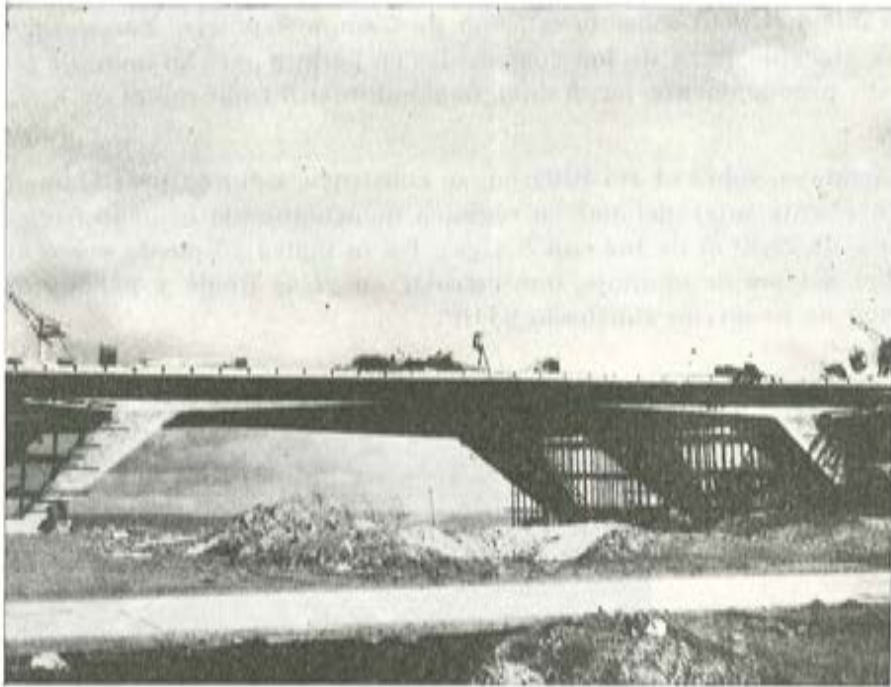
Paso superior en los accesos al Aeropuerto de Barajas (Madrid)
